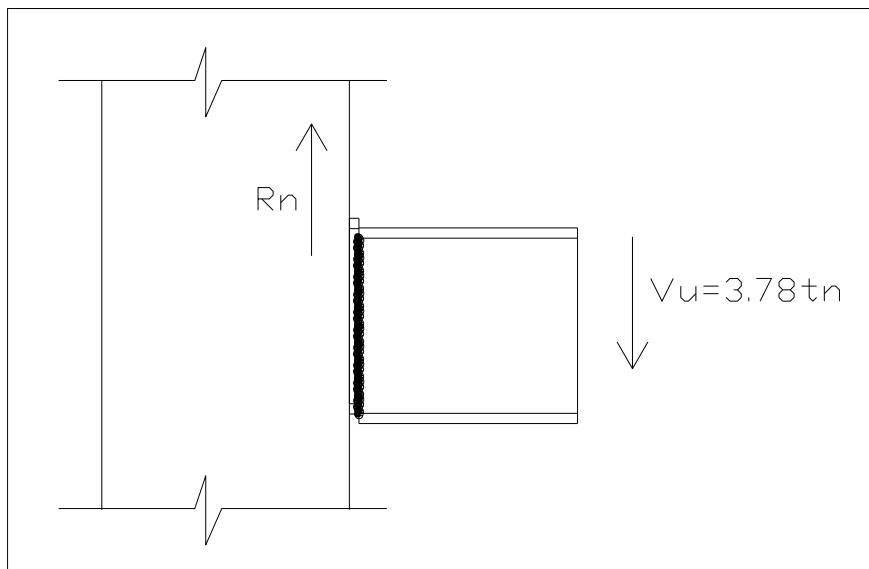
Esfuerzos actuantes para el diseño de la soldadura del alma de la viga.
